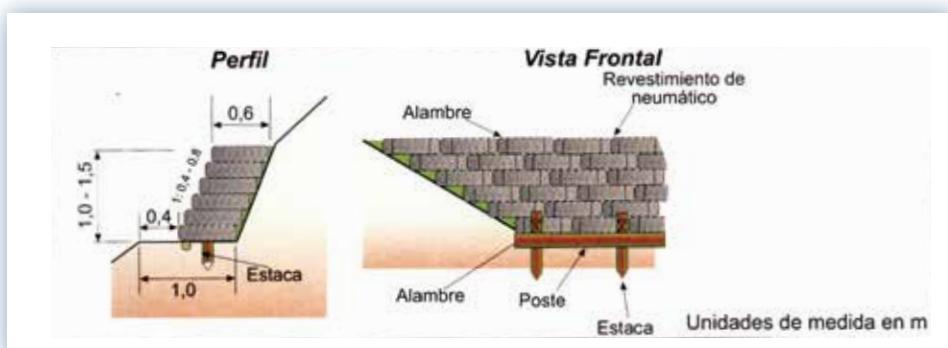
Esquema de construcción de muros con llantas o neumáticos, tomado de Francke et ál.(2004).
